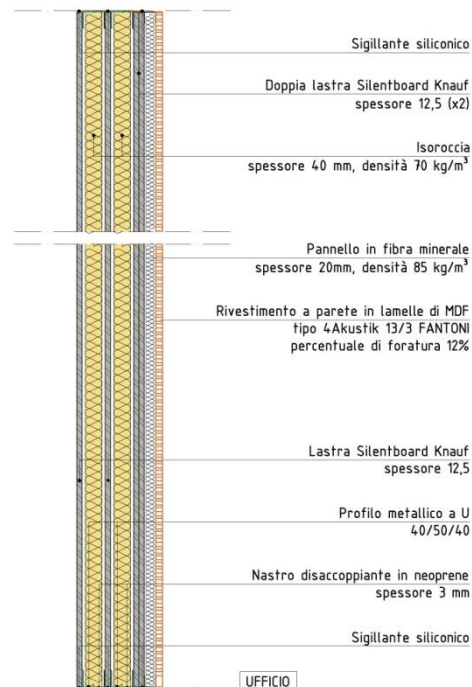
Sezione schematica della tipologia di parete divisoria di progetto, avente $R_w = 65$ dB
